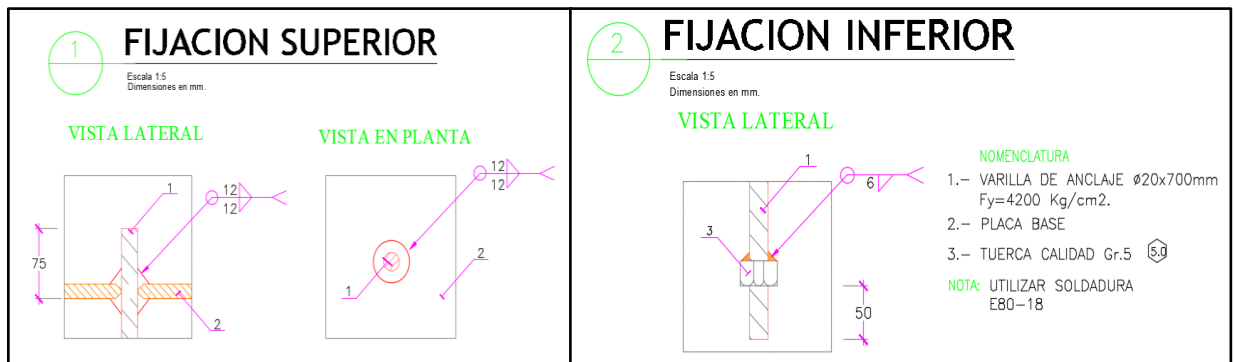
Detalle de varilla de anclaje soldada
